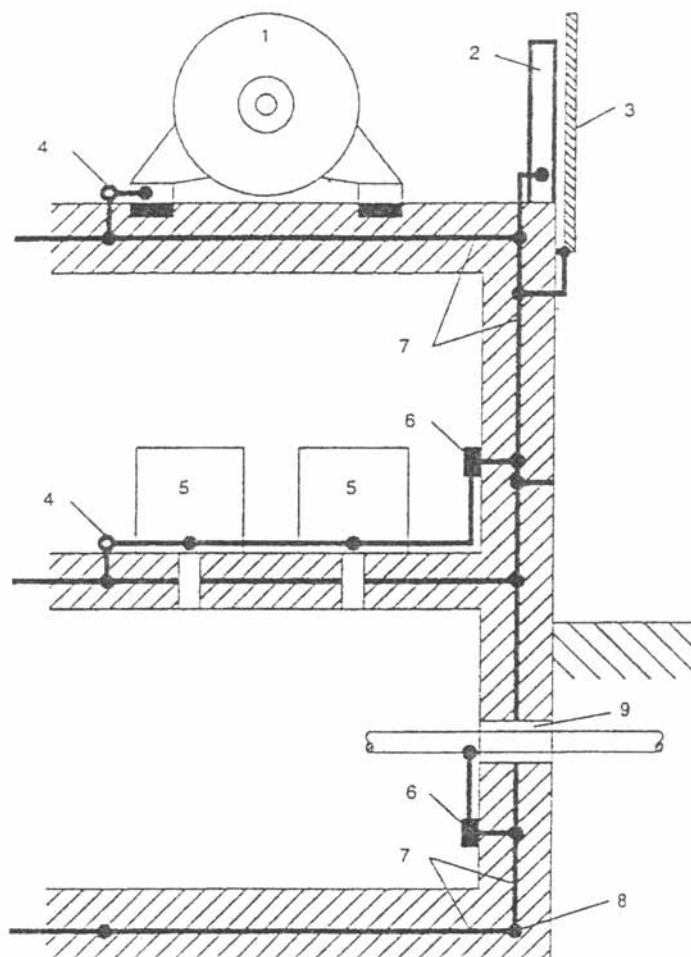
一钢筋混凝土建筑物内等电位连接的例子
